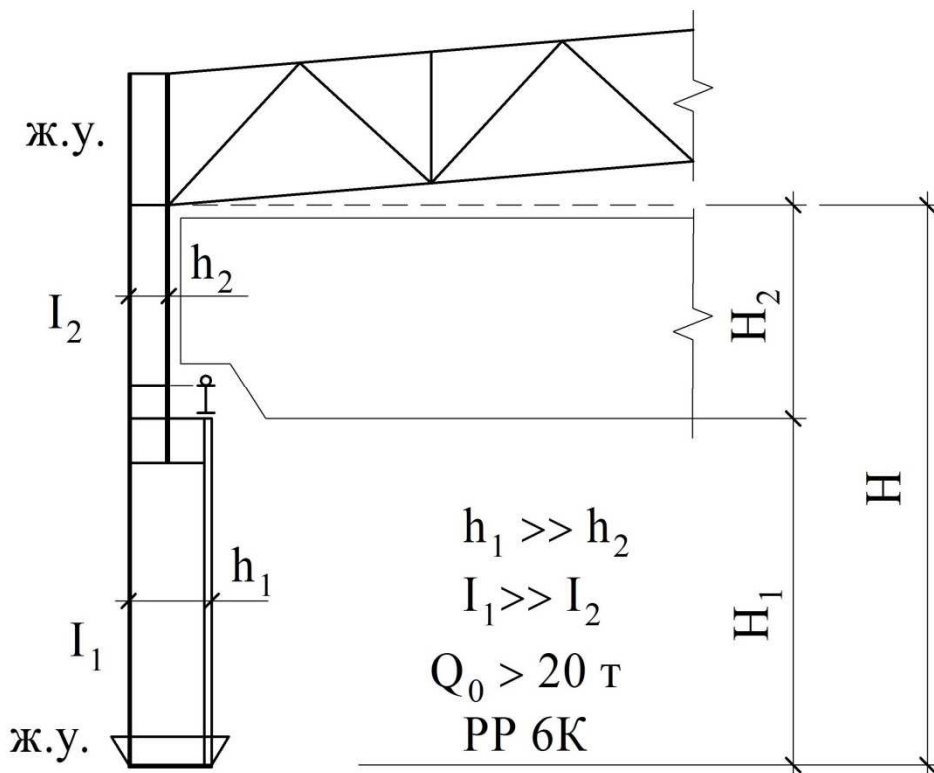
, б – Конструктивная схема однопролетной поперечной рамы со ступенчатыми колоннами: верхние и нижние узлы - жесткие
